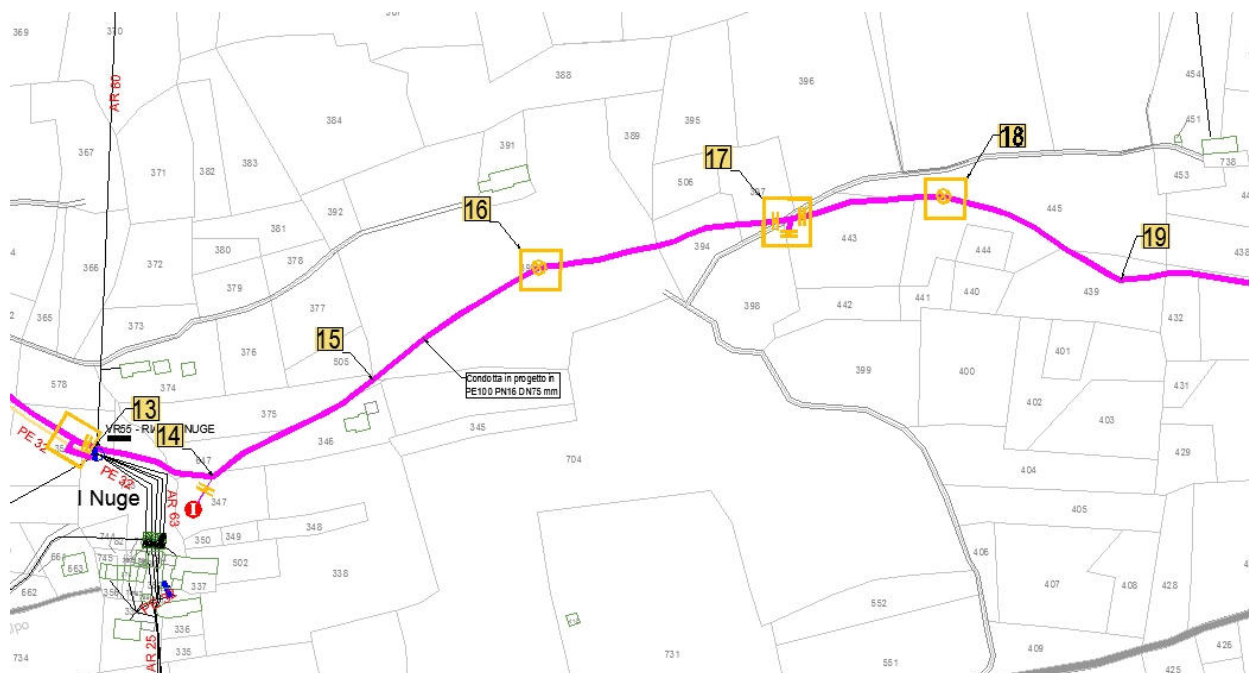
nuova condotta a progetto tra la Sezione 13 e la Sezione 19 su stralcio planimetria catastale.
